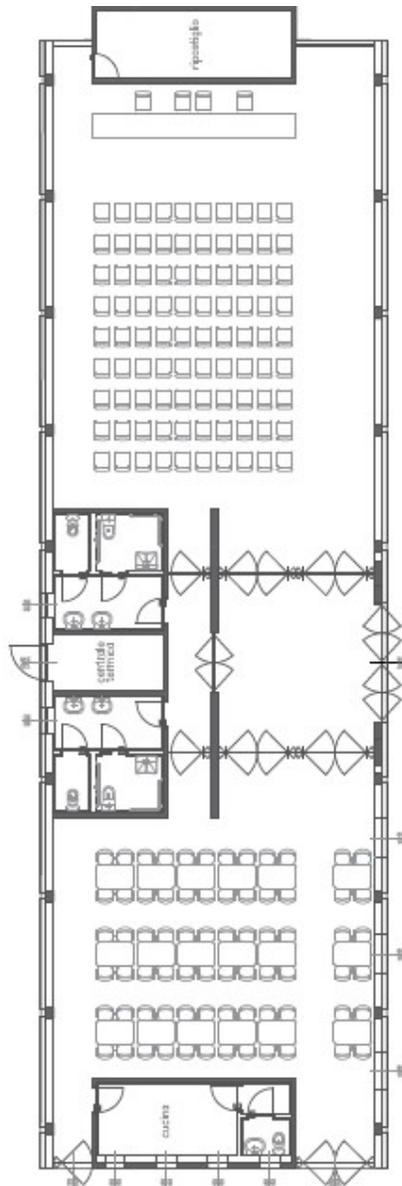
PLANIMETRIA PIANO TERRA MENSA
